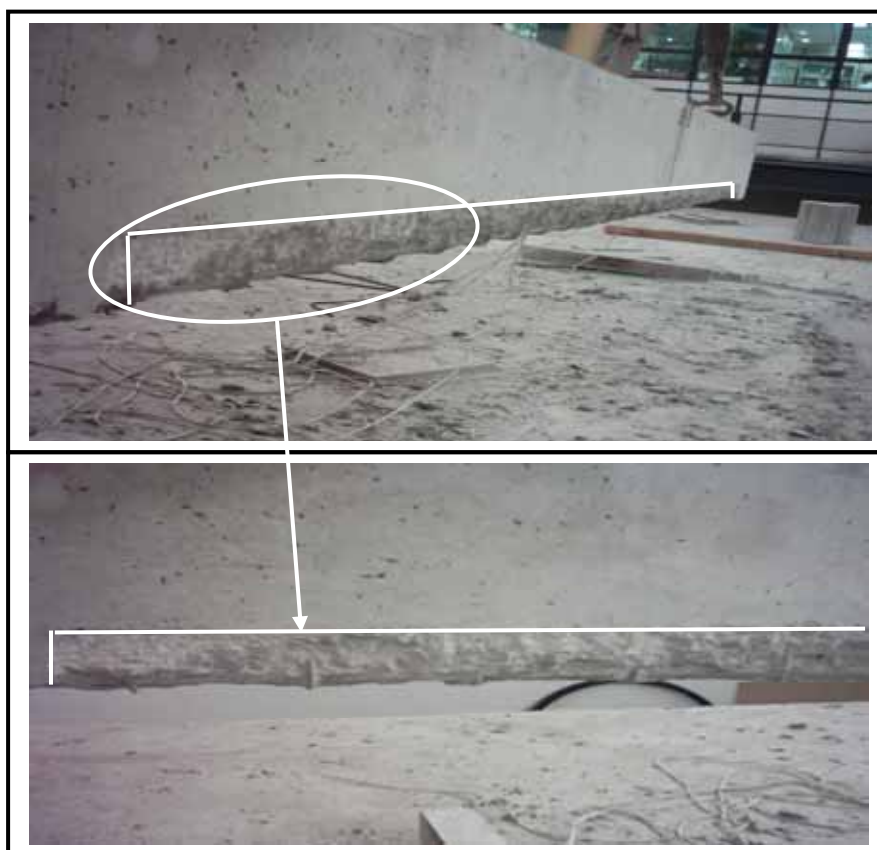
Região da face lateral da viga submetida ao apicoamento.
